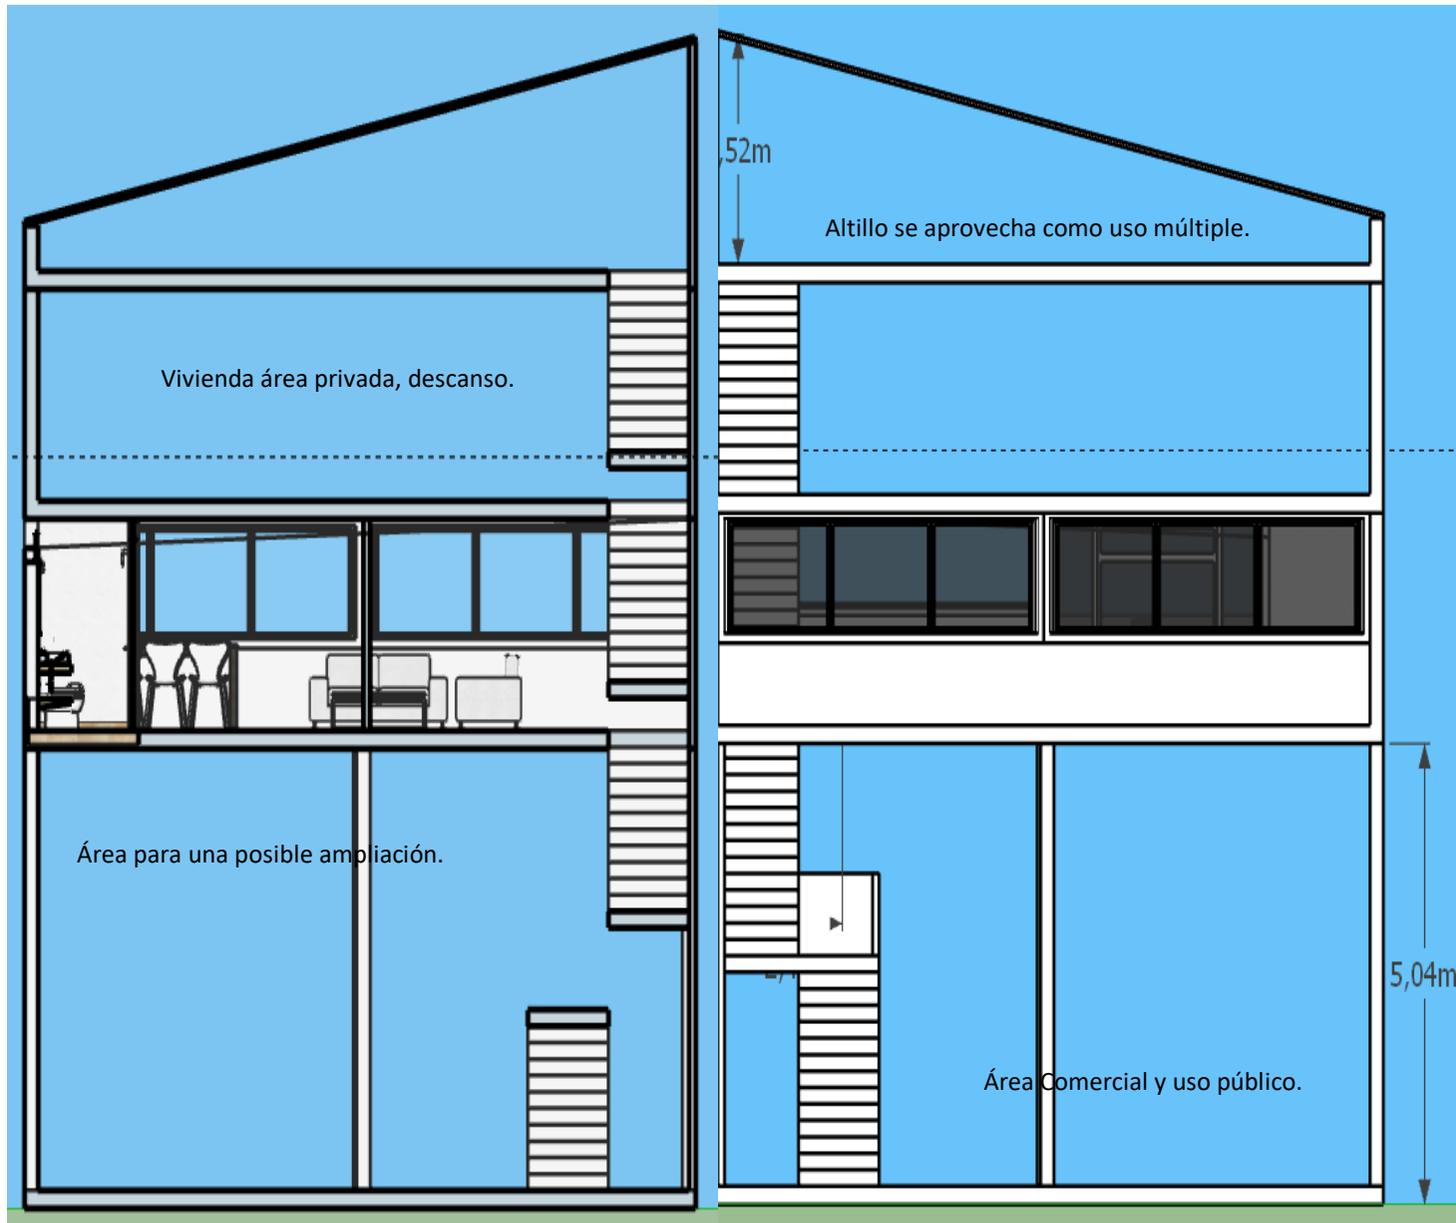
Andino, E. (2020)*. Esquema de diseño de fachada. Elaboración propia
